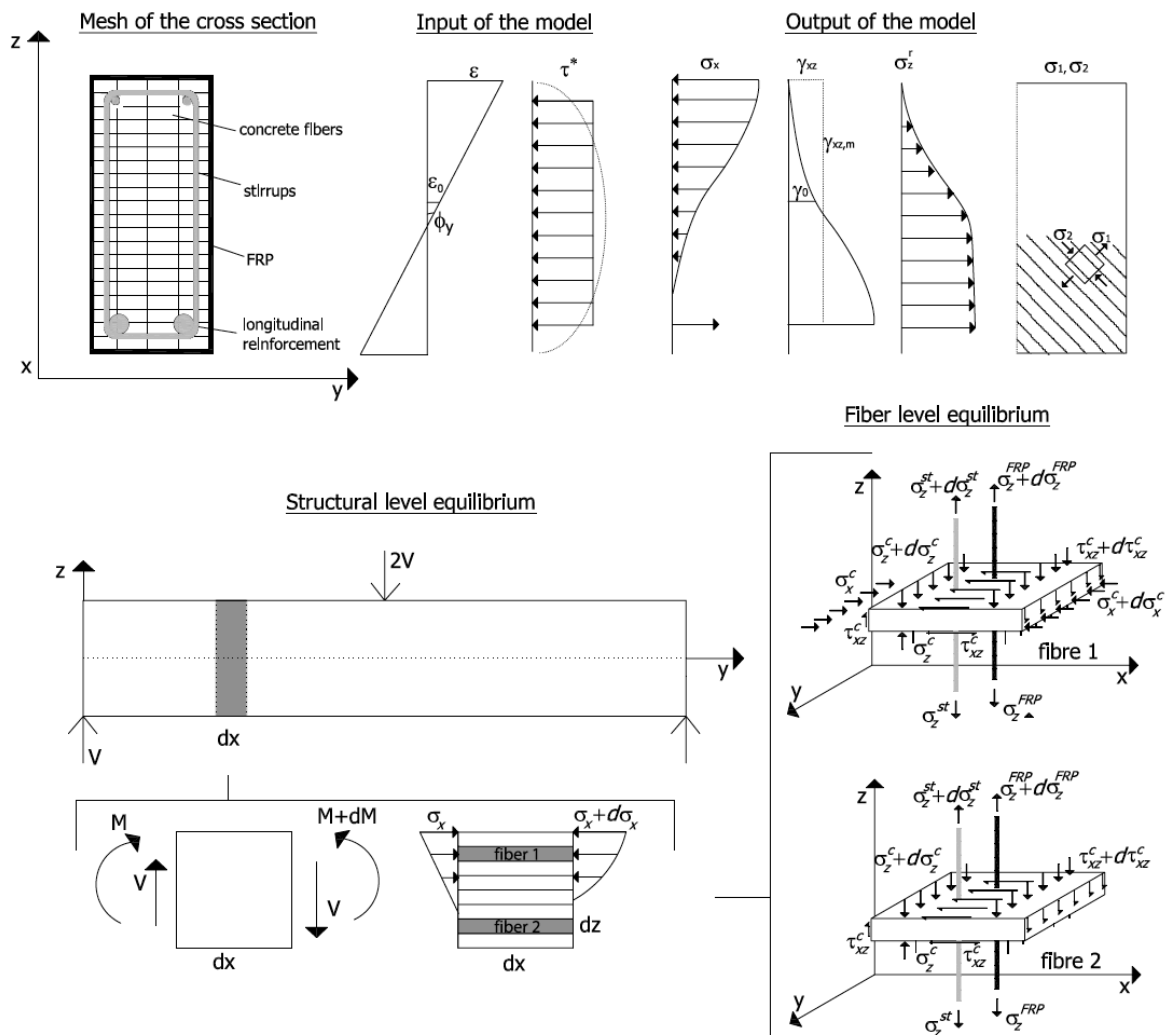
Sección de modelo híbrido N-M-V.
